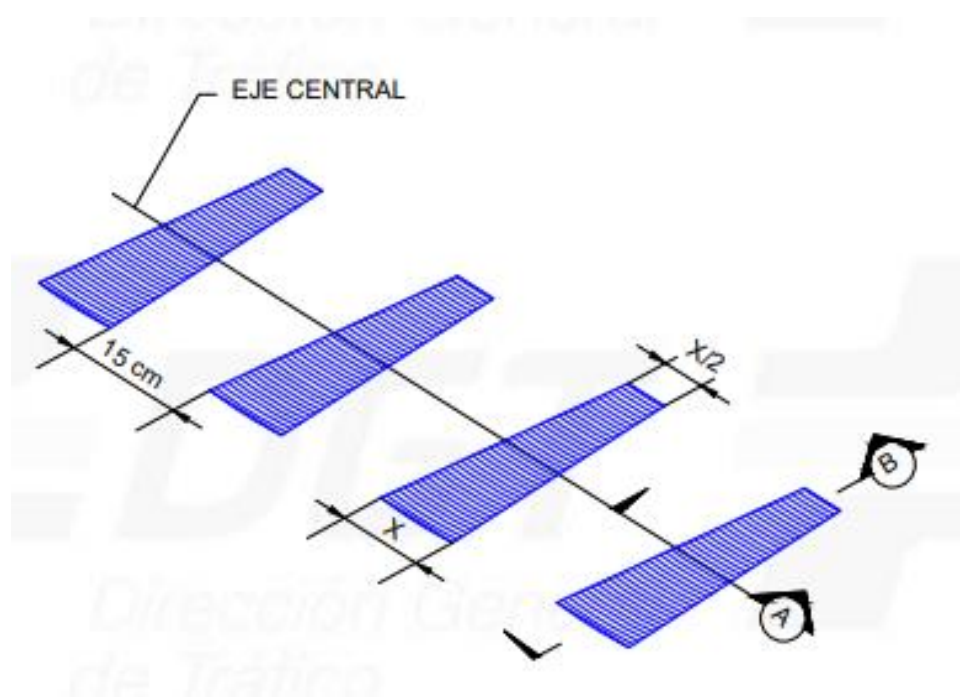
DGT (2018). Vista isométrica de guía sonora longitudinal de tipo trapecoidal
